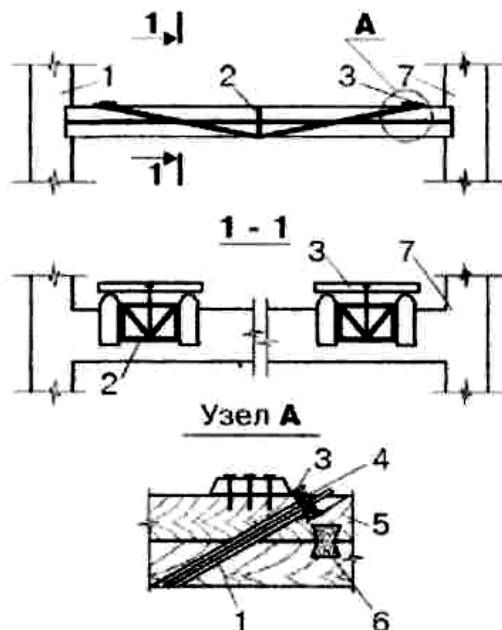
Схема підсилення дерев'яних балок шпренгельними затяжками: 1 - металева затяжка; 2- металева рама; 3- опорний майданчик; 4 - гайка; 5 - дерев'яна складена балка, що підсилюється; 6 - шпонка; 7 - існуючі стіни
